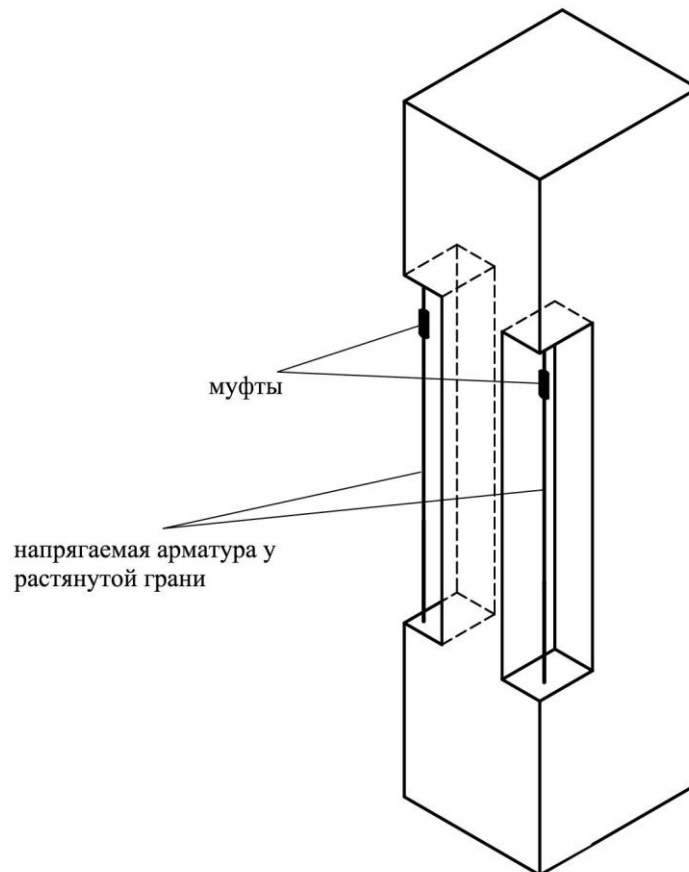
Схема изготовления колонны с предварительно растянутой арматурой у растянутой грани (поперечная арматура условно не показана)
